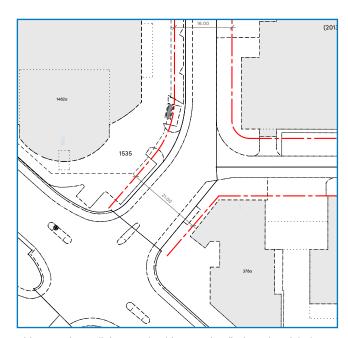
Die Baulinien werden bis zum Einmündungsbereich der Holzhäusernstrasse fortgesetzt.
